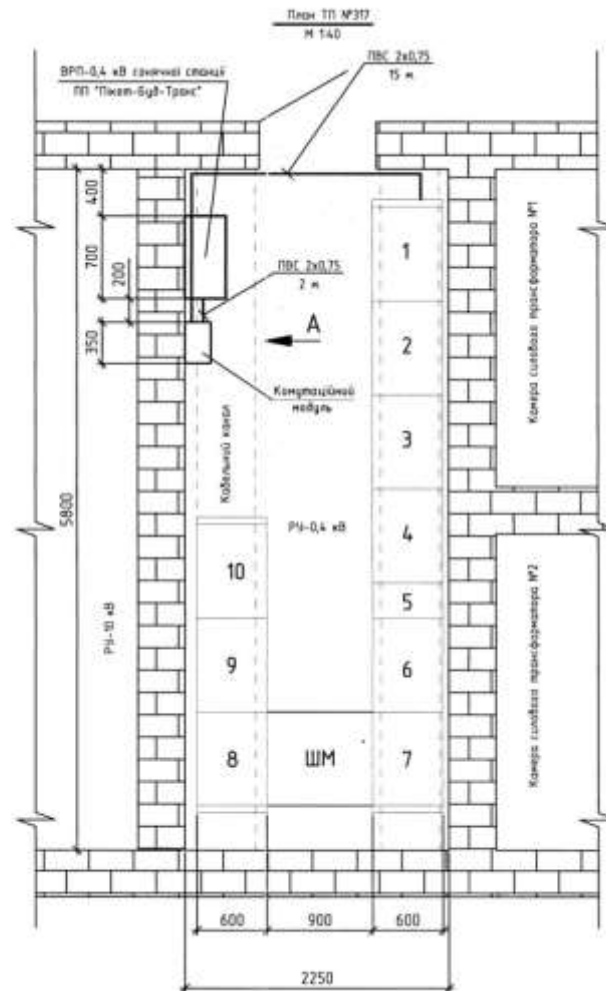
Схема плану розміщення обладнання АСКОЕ та прокладки кабелів
